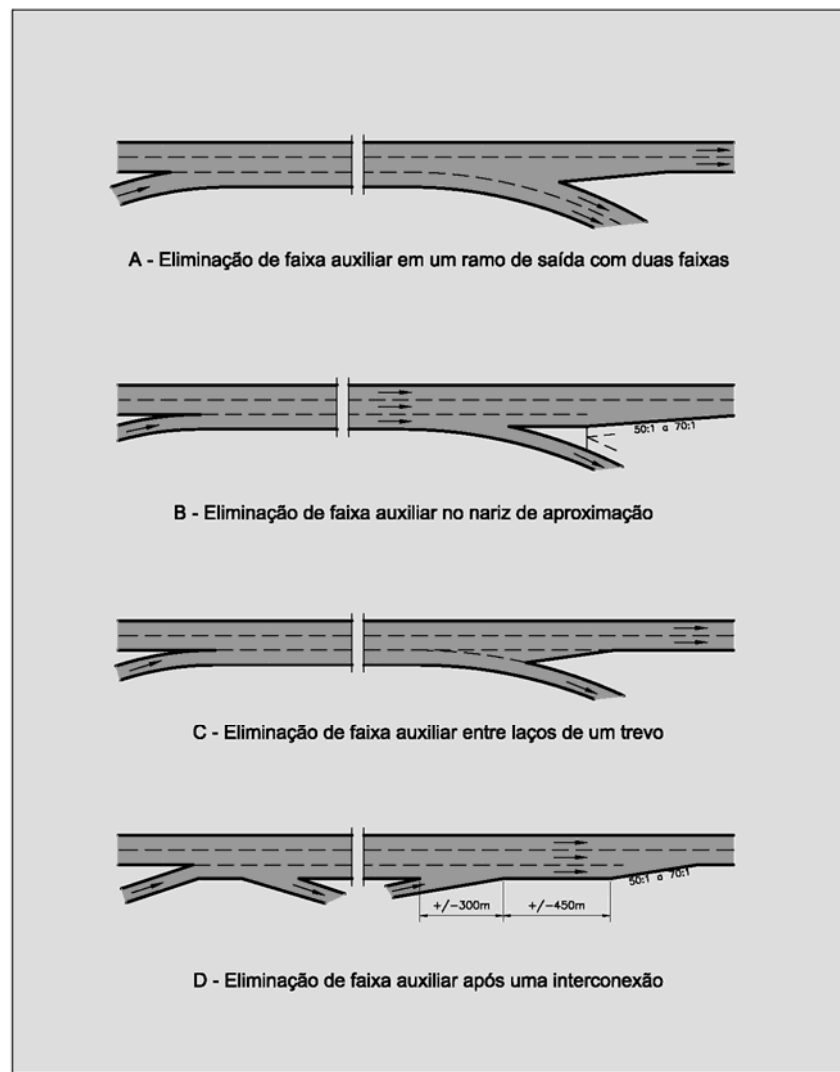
Métodos alternativos de eliminação de faixas auxiliares
